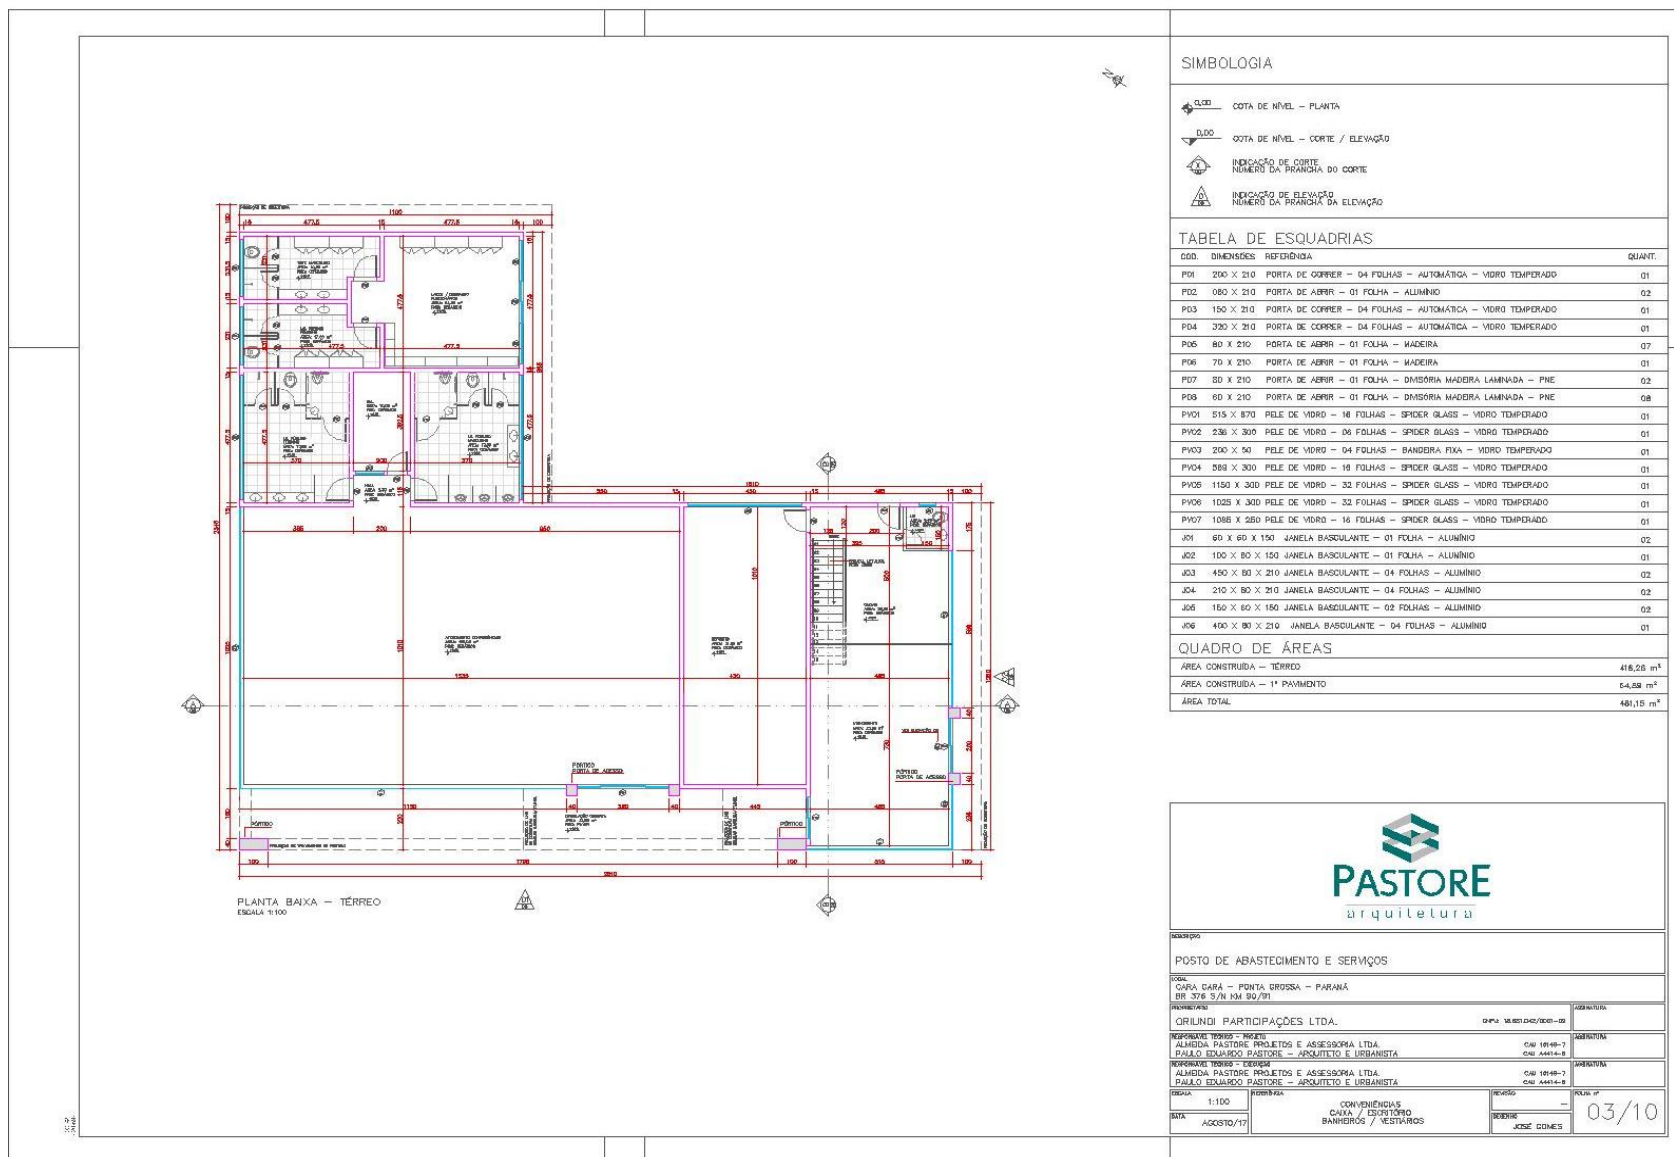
Planta baixa: conveniências, caixas, escritório, banheiros e vestiários.
